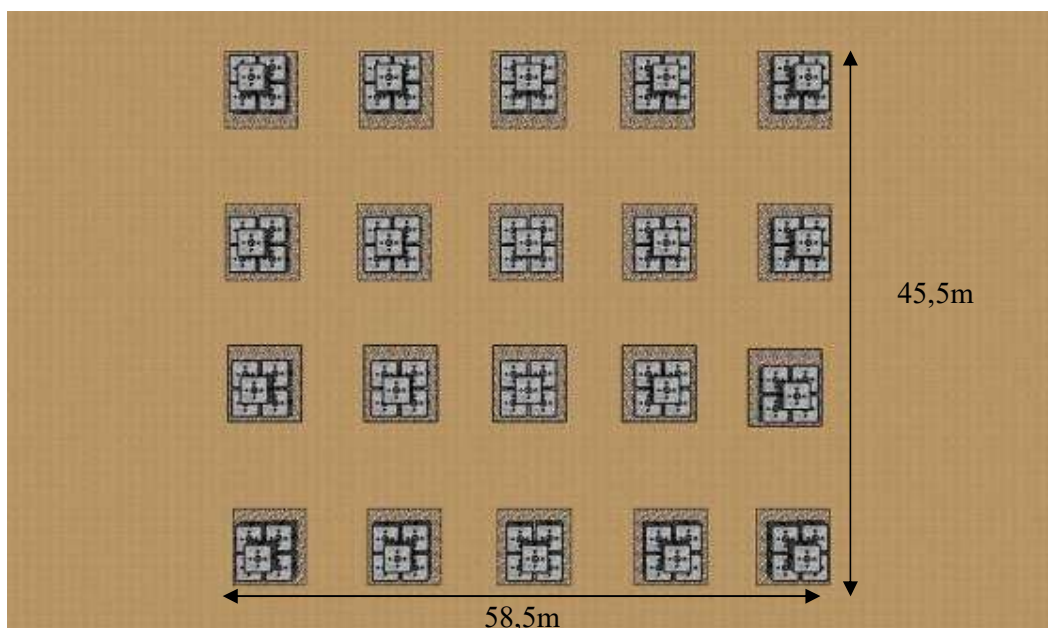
Planimetria delle strutture costituenti il lotto centrale di intervento
